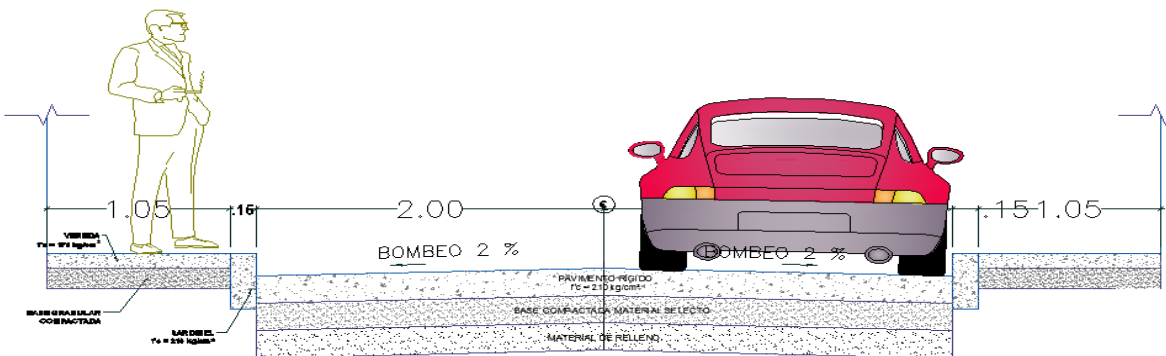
Detalle corte 1-1 Av. Los Rosales
